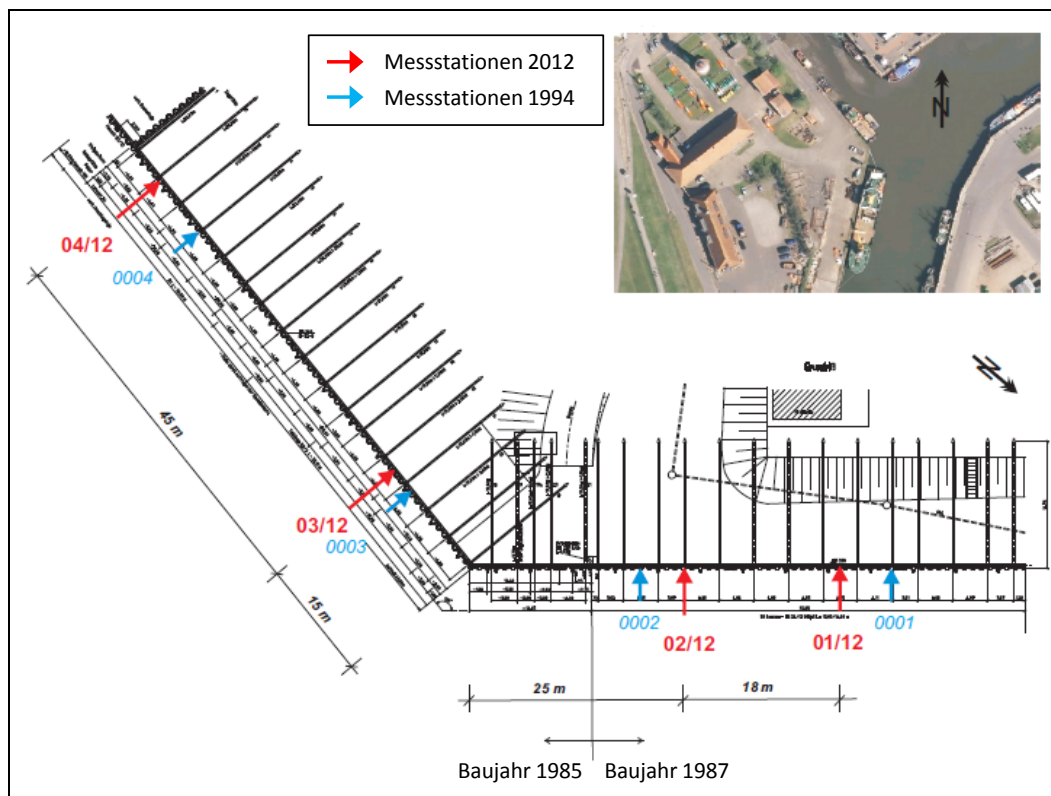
Lageplan mit Kennzeichnung zweier getrennt ausgewerteter Teilbauwerke („Baujahr 1985“ und „Baujahr 1987“) und Stationen der aktuellen und einer früheren Messkampagne
